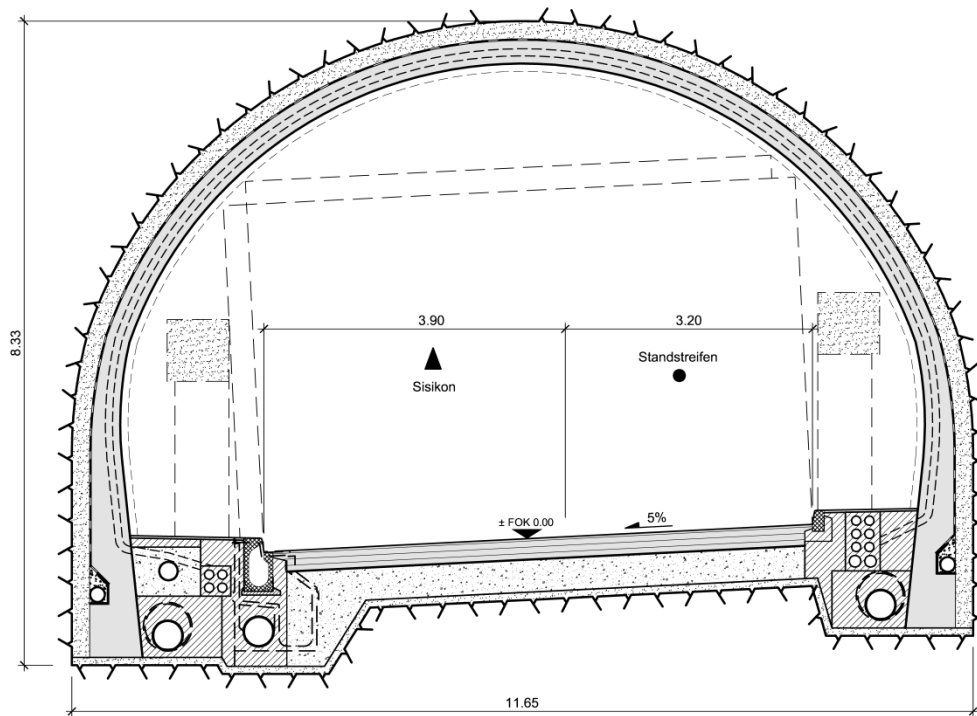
Normalprofil Ausfahrtstunnel Gumpisch
